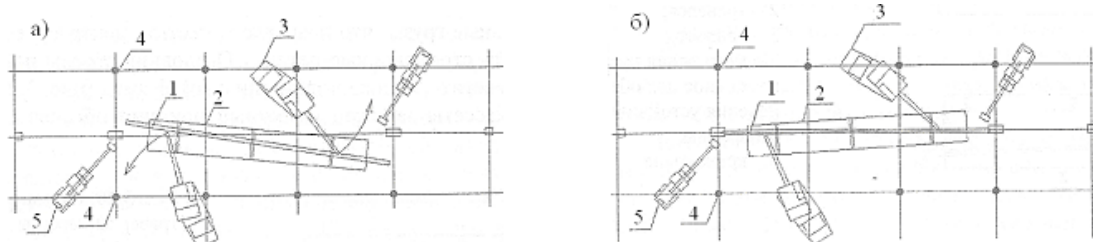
Схема установки подстропильной фермы с помощью траверсы-кассеты:
